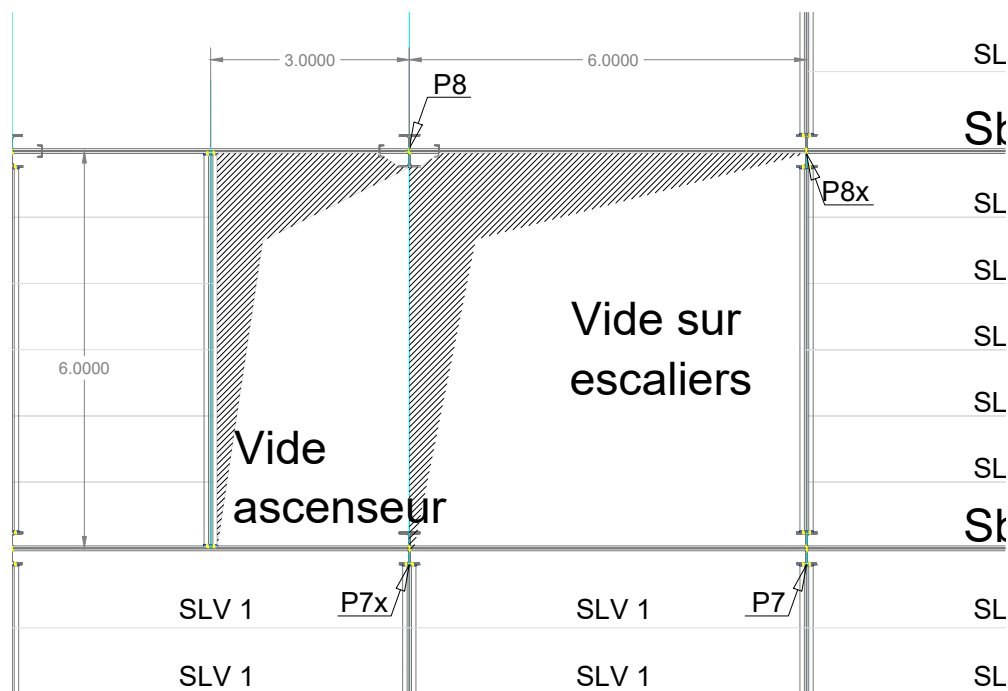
Implantation de l'escalier dans la trémie du plancher
